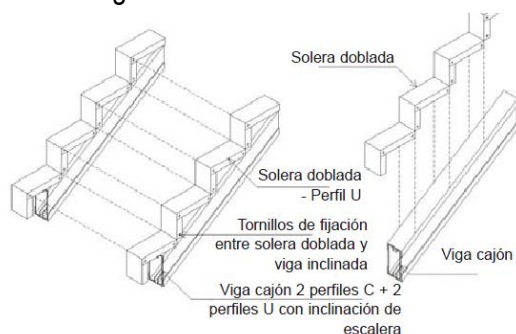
Esquema de escalera viga tubo inclinada. (Sarmanho Freitas & Moraes de Crasto, 2007).
